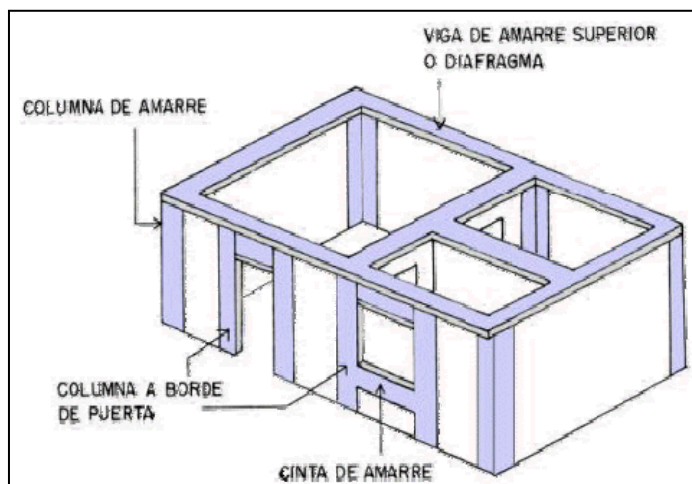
Refuerzo en la edificación: colocación de una viga collar y columnas de concreto reforzado
